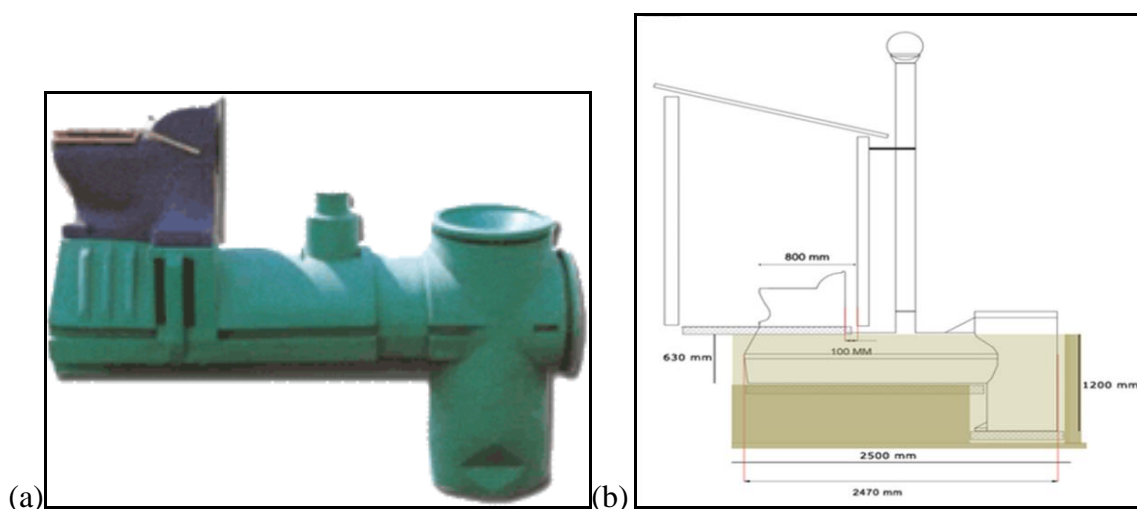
Banheiro Seco EcoSan. (a) Detalhe do sistema pré-fabricado. (b) Corte lateral esquemático.
